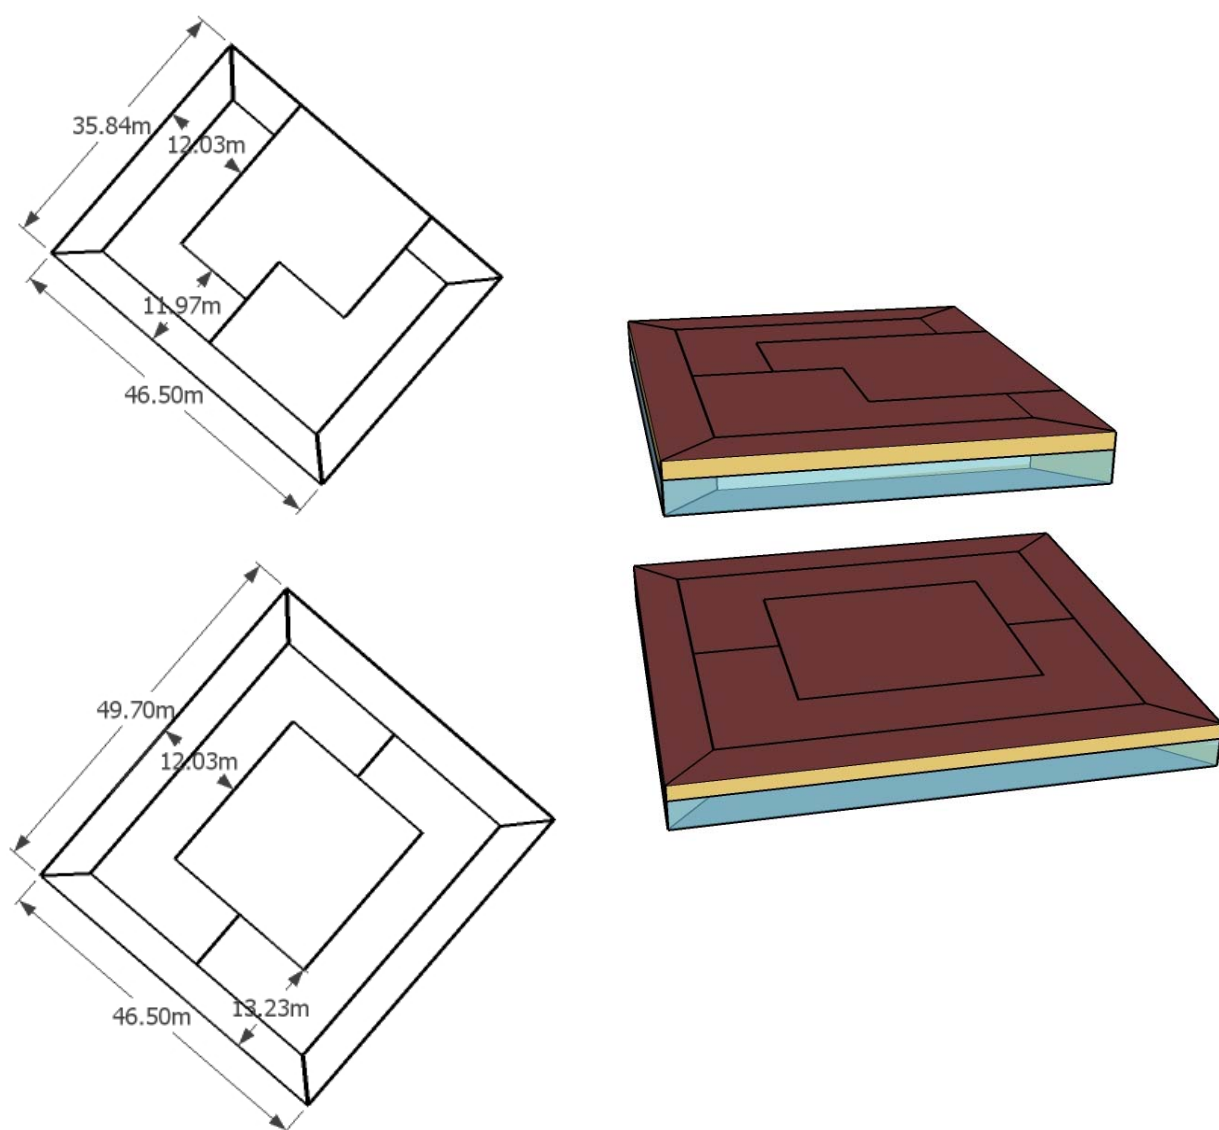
Plantas e modelo espacial de pavimentos tipo Proposed Building para o estudo de caso #6
